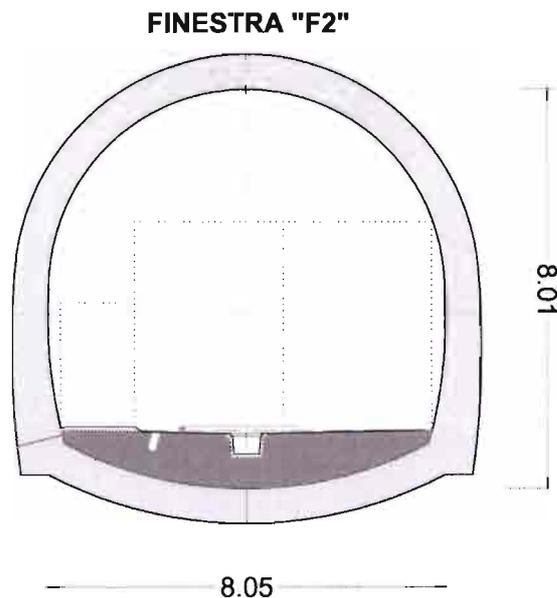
Sezione trasversale finestra costruttiva.
